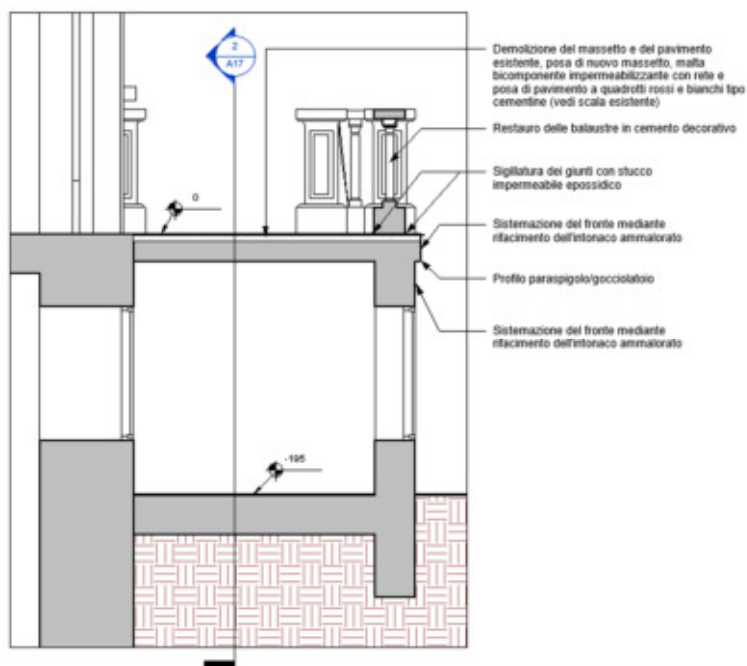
Restauro conservativo scale esterne 01 – Sezione B
